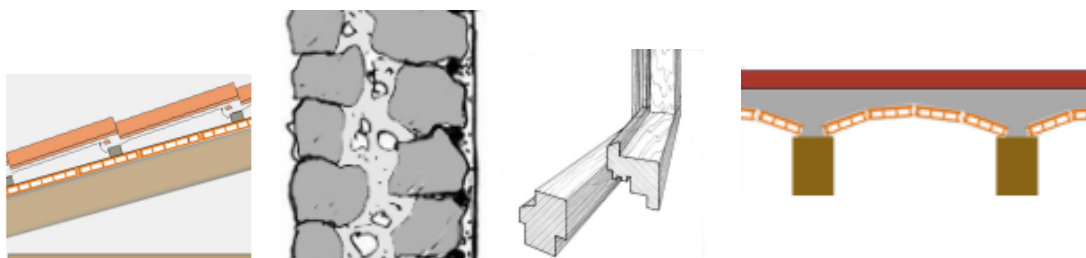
Esquemas constructivos Cubierta, Fachada, Carpintería, Forjado. Fuente TABULA [108]
